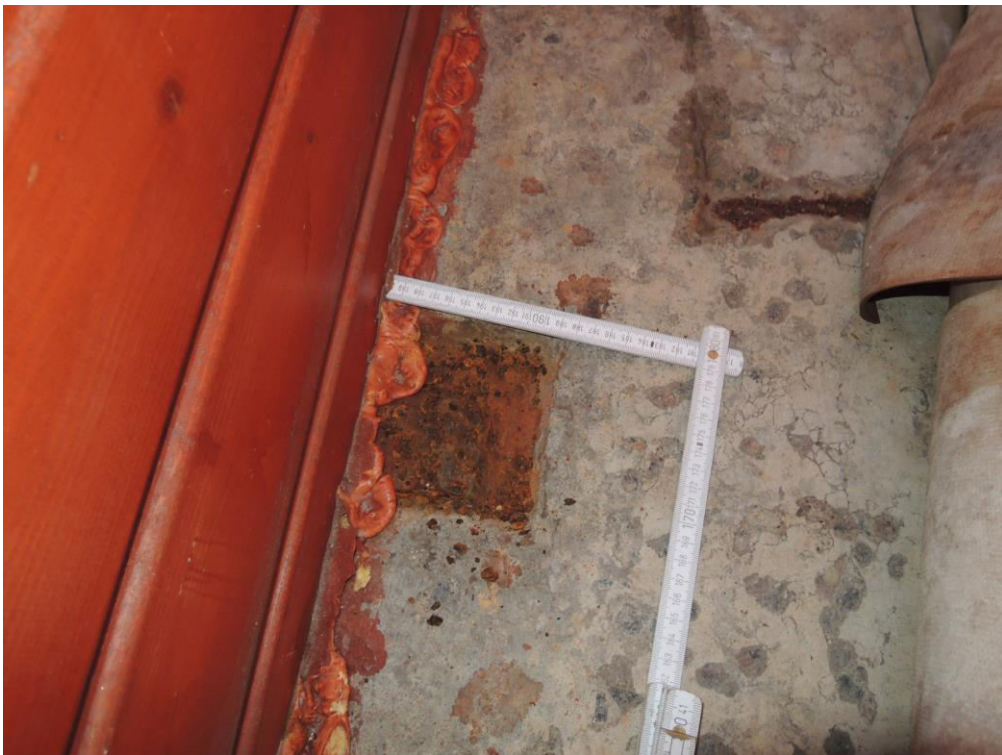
Krt. 65. Rõdu põrand ja roostetanud alumine kinnituselement.
